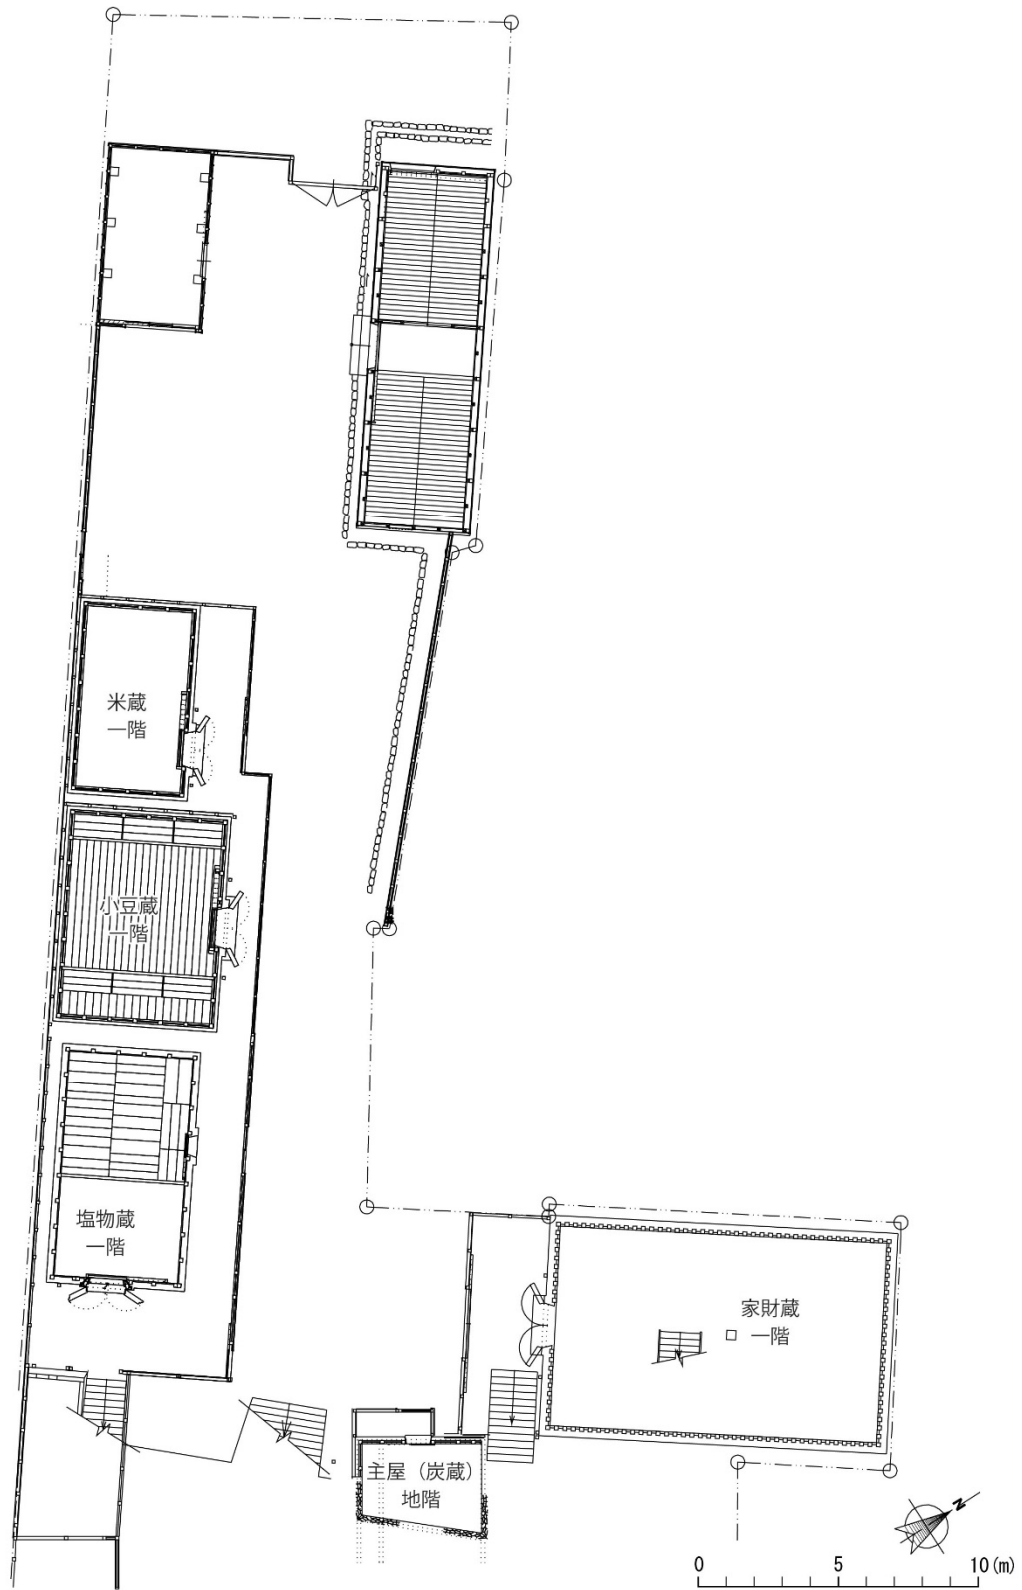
旧角海家住宅 平面図（主屋（炭蔵）地階、家財蔵一階、塩物蔵一階、小豆蔵一階、米蔵一階）
